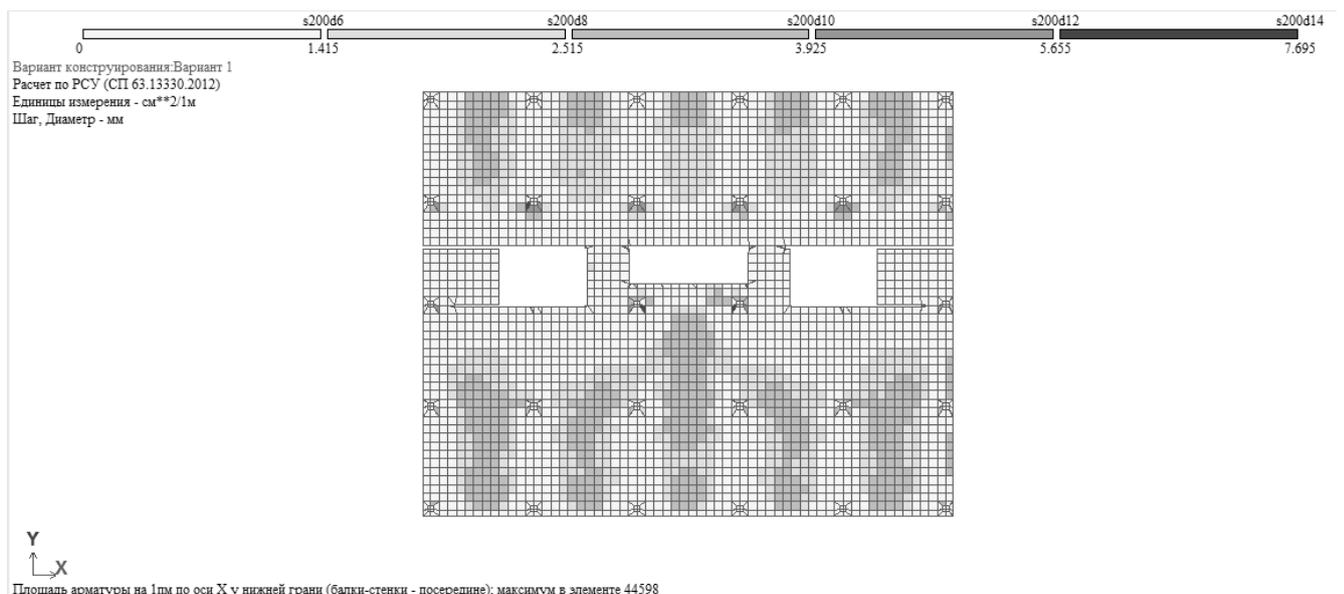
Нижнее армирование плиты перекрытия по оси X
